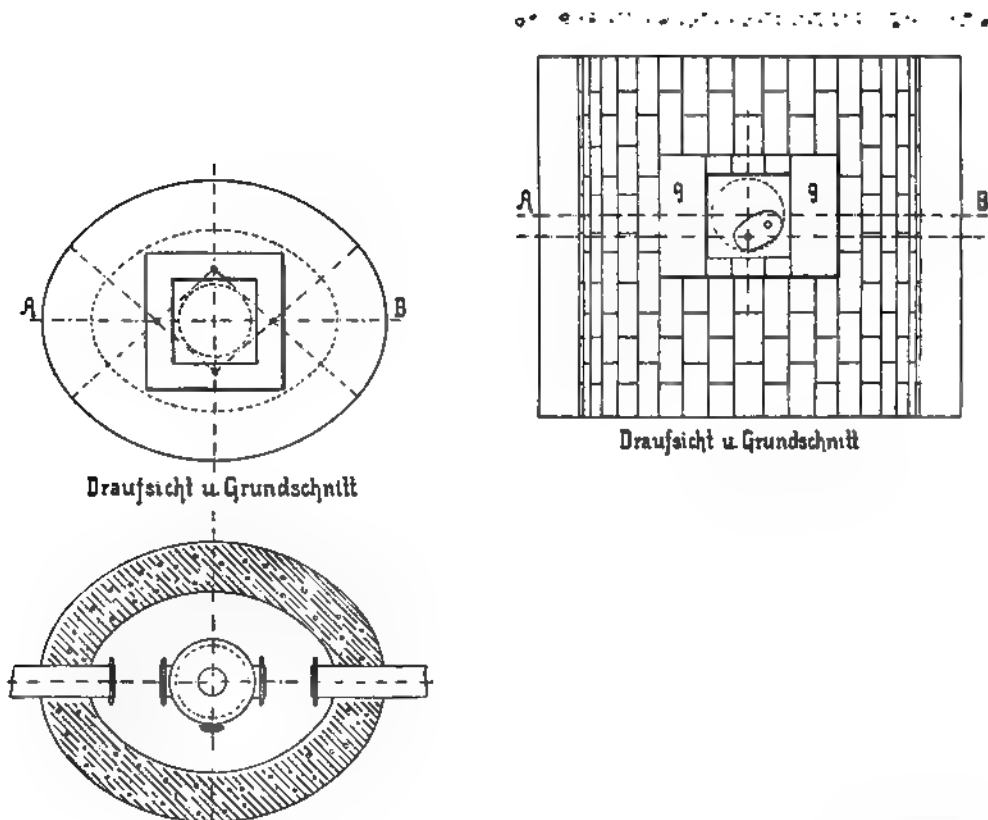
Teilkastenschacht aus Beton (Lahr)
